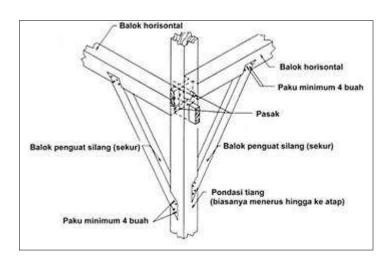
Hubungan Tiang Pondasi, Balok, dan Telapak
